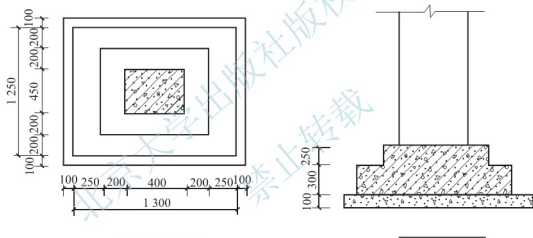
钢筋混凝土独立柱基础平面图、剖面图
